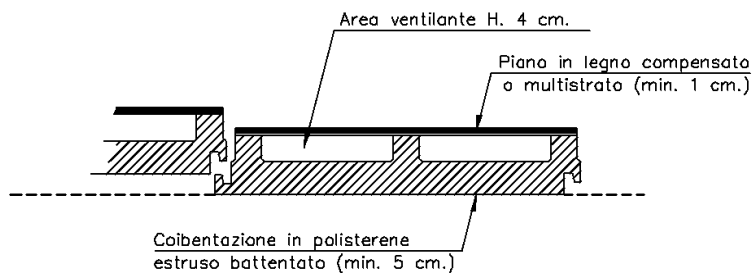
Ex-Lavanderie - stato di progetto: particolare struttura ventilata di copertura (Particolare "A")
